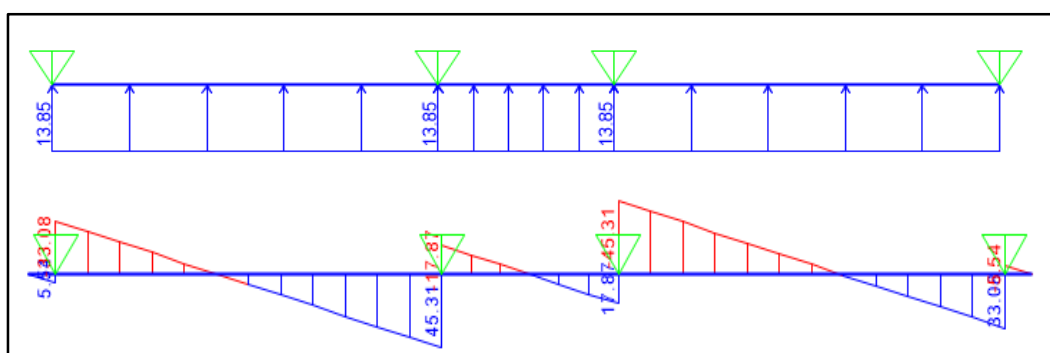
DFC de la losa – Losa de cimentación sin viga - Sistema dual tipo I
